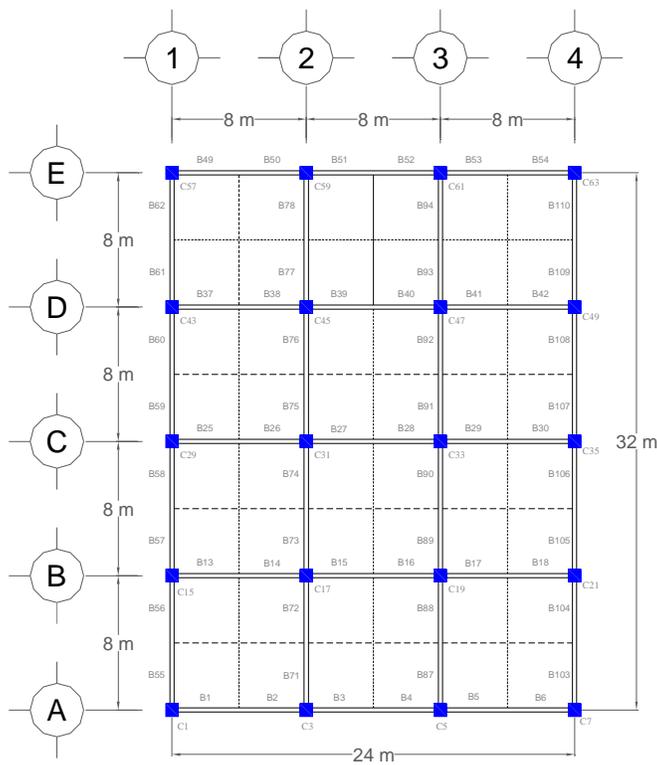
Planta tipo del edificio de 9 niveles
